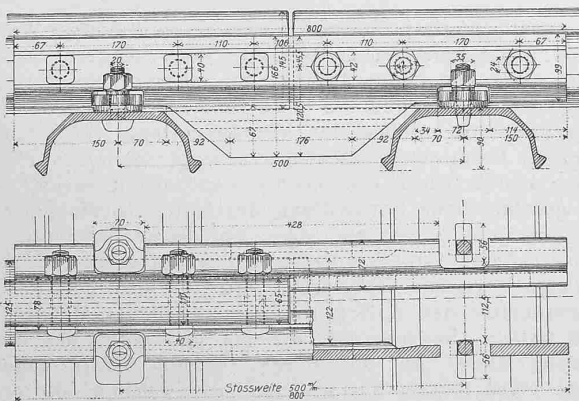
Stossverbindung. — Grundriss, Ansicht und Schnitt 1 : 10.
